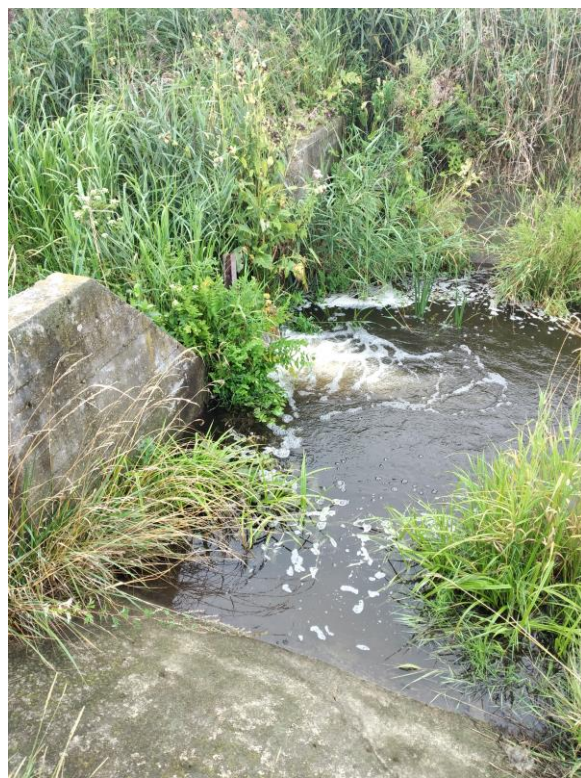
Widok z pozostałości przepustu z piętrzeniem w km 23+096
